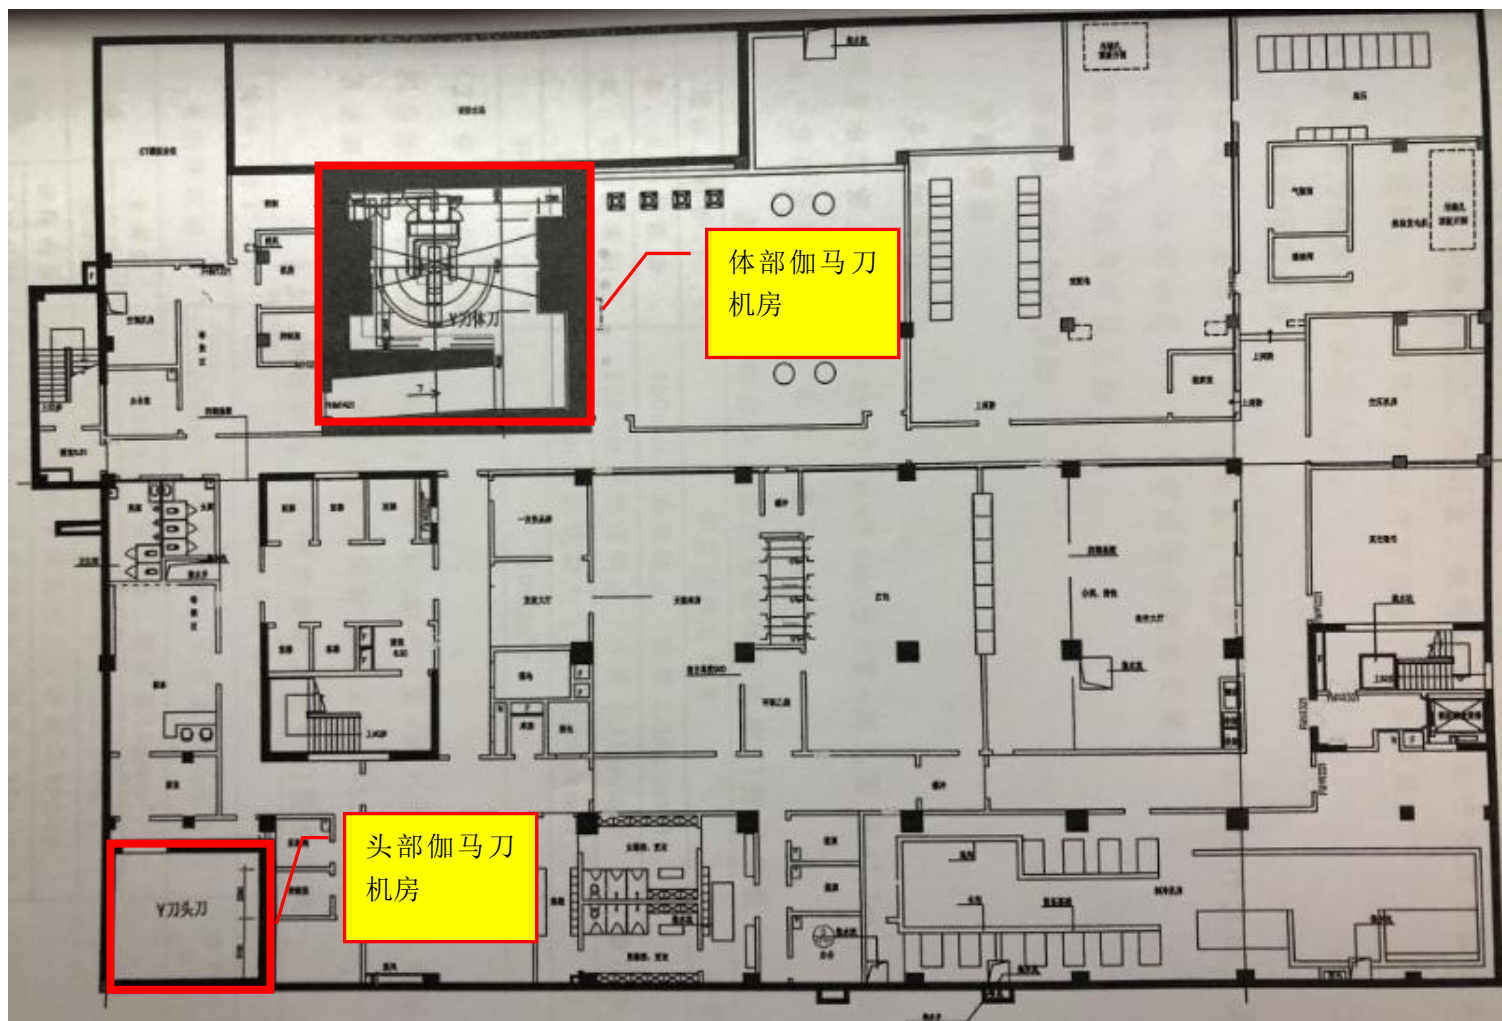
伽马刀机房所在楼层（地下一层）平面布置示意图
